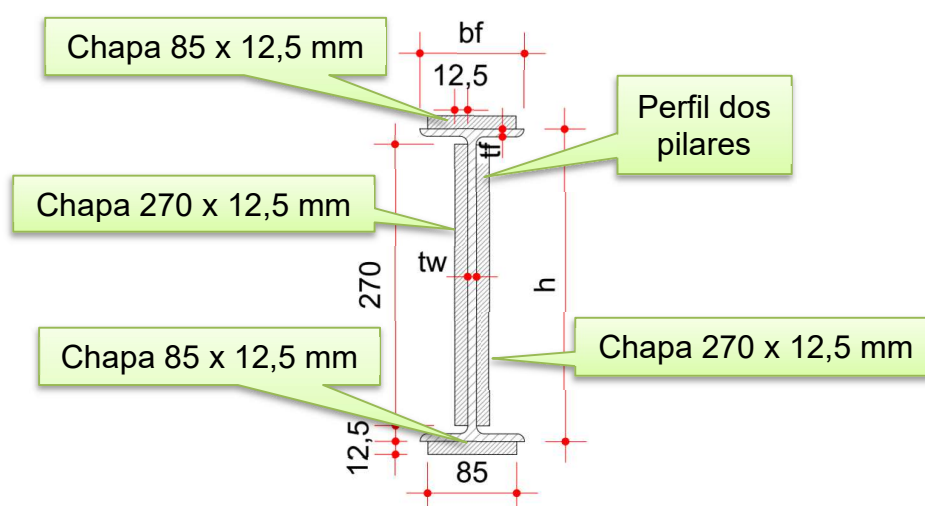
SEÇÃO DOS PILARES REFORÇADOS - VÃO DE 7,75 M
